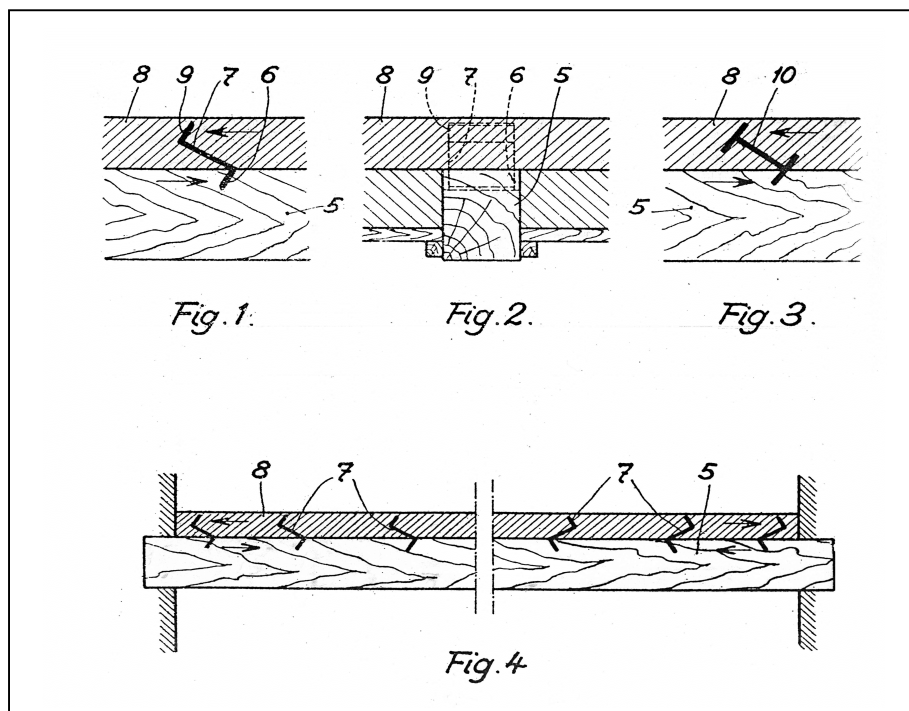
Holz- Beton- Verbund- Decke, Reichspatent 673556 [53]
